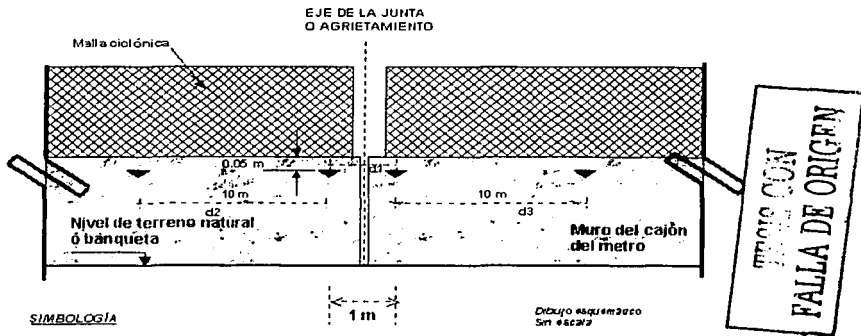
Arreglo de testigos en muros o palomas para instrumentar las juntas constructivas y en zona de cajón fisurado.
